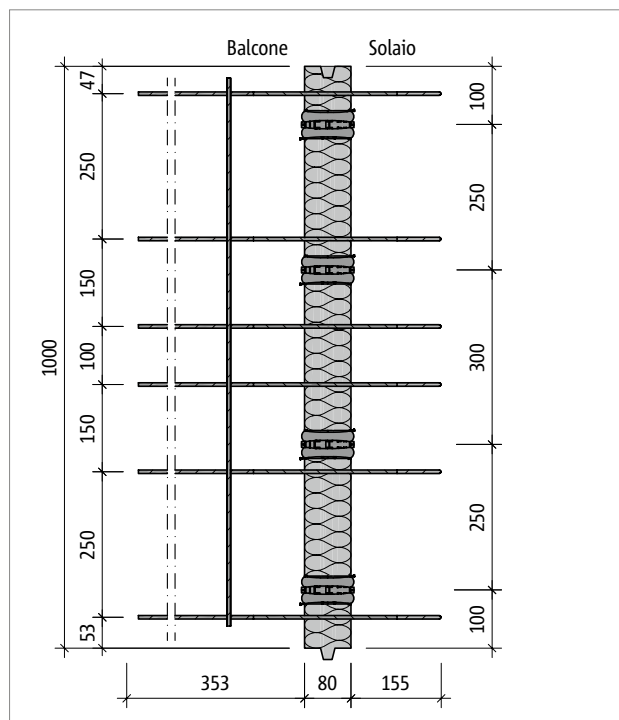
Schöck Isokorb® T tipo QL-V1: pianta del prodotto
